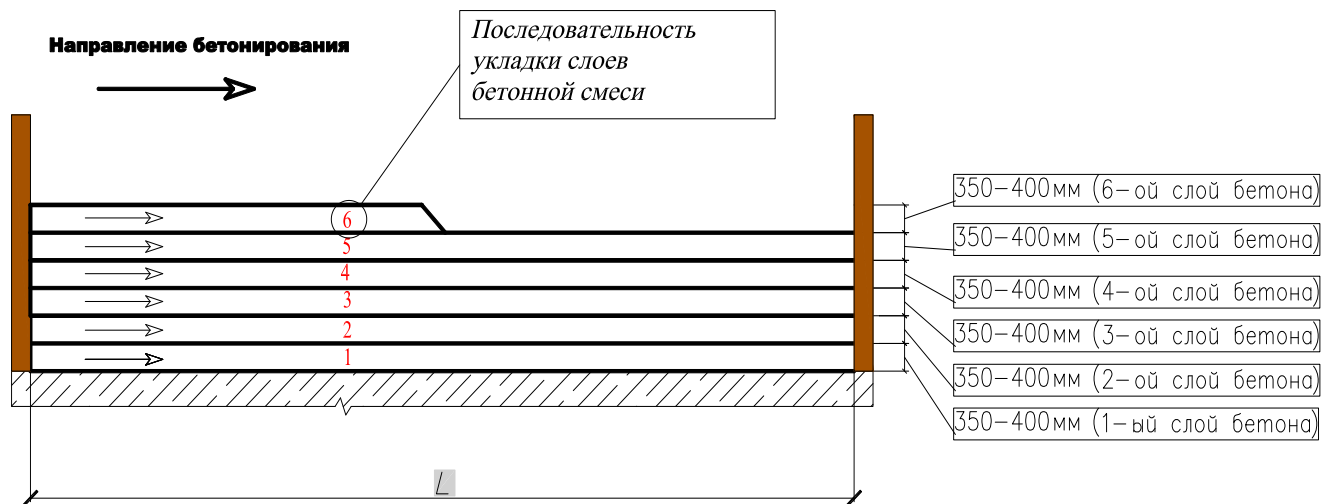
Схема послойной укладки бетонной смеси в захватки бетонирования
